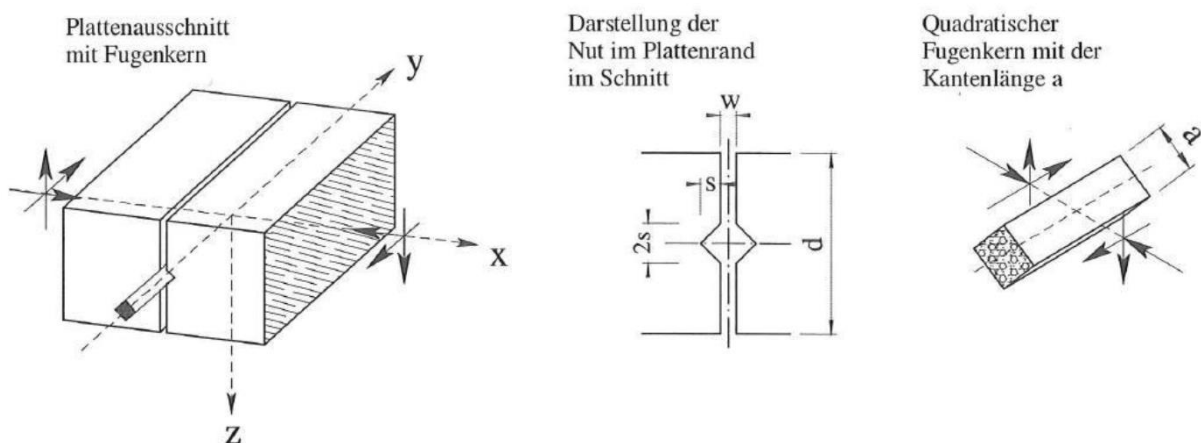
Demontables Deckenfuge mit dem Fugenkern aus Aluminiumschaum [WEI03]
